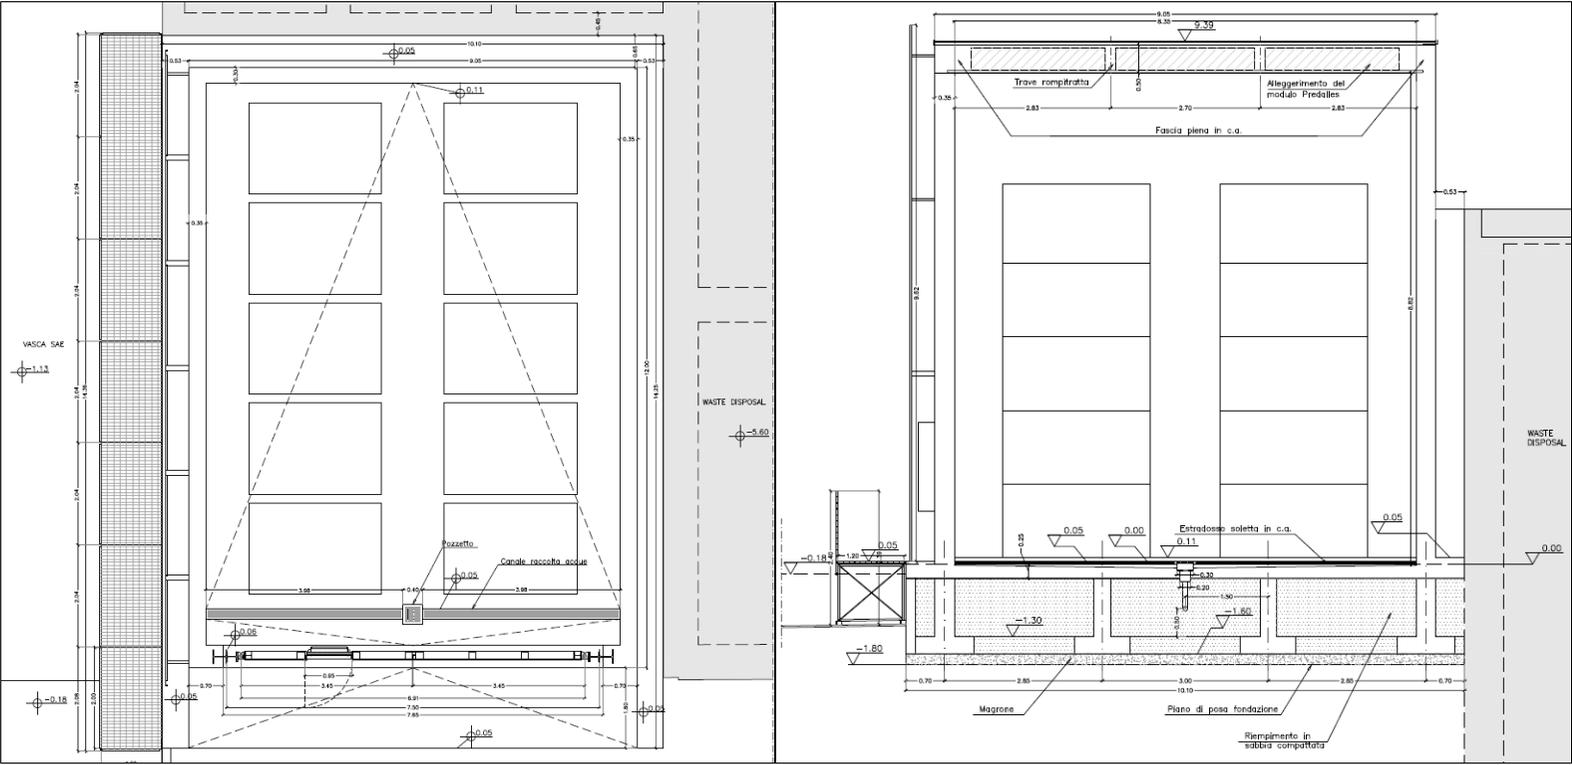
Test Tank - pianta Quota 0.00 (piano di caricamento) e sezione trasversale *post operam
